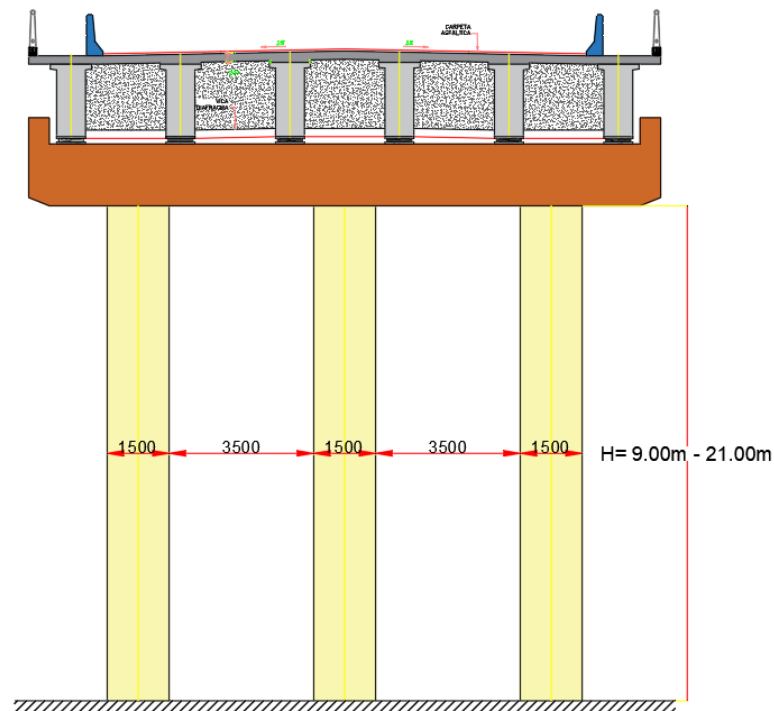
Elevación Transversal de Puente-Zona de Pilar.
